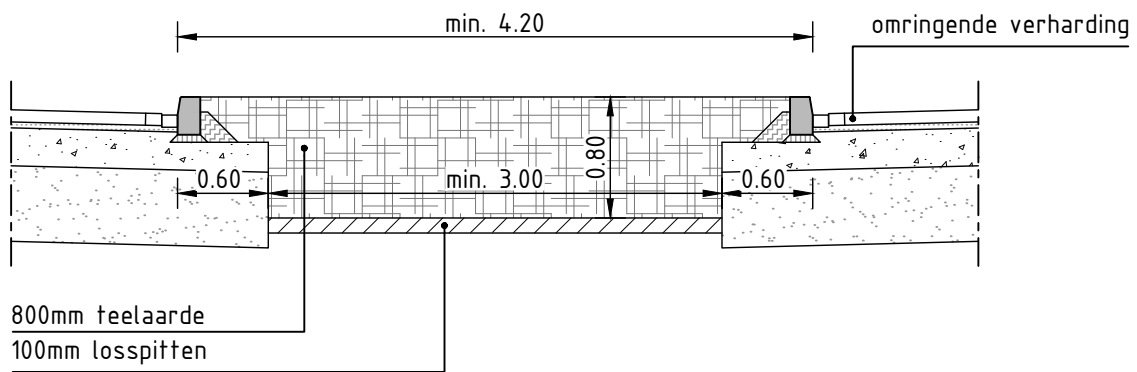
Plantplaats: beplanting, gazon of berm in bestaande grond
